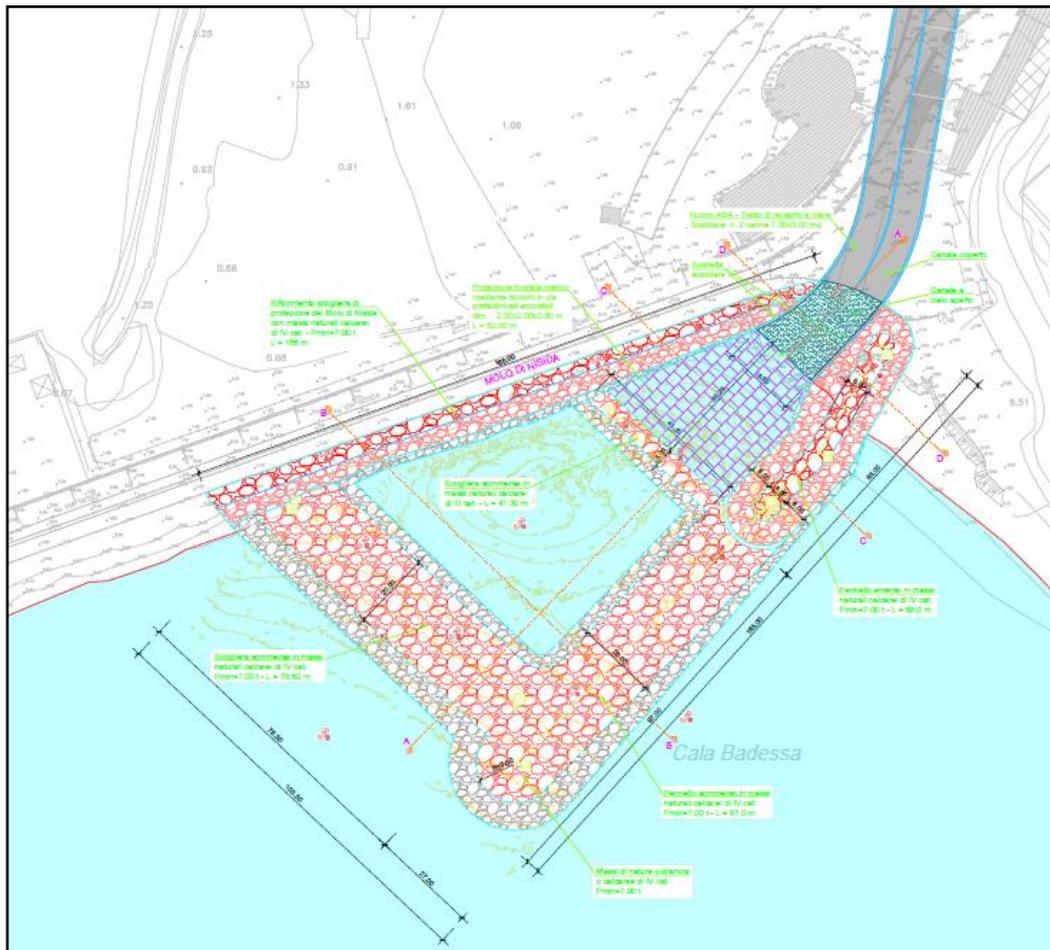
Stralcio planimetrico sbocco a mare (PD)
